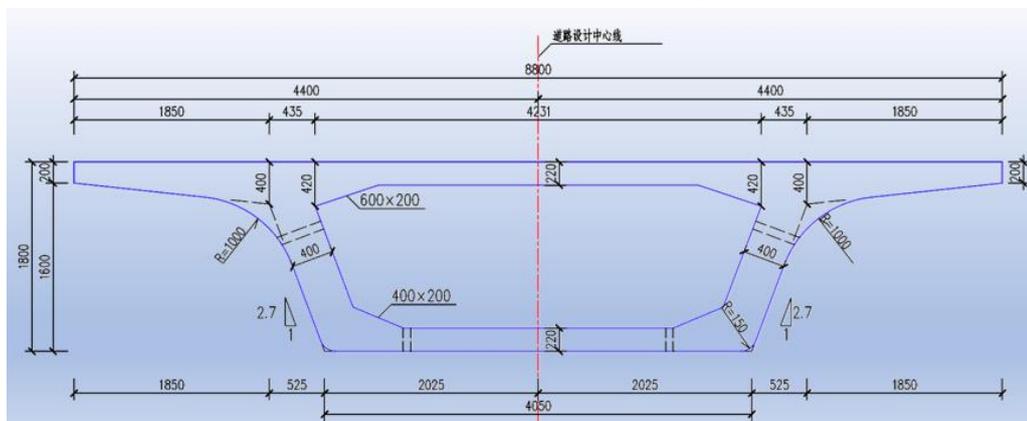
匝道 B=9.0m 预应力箱梁横断面图
